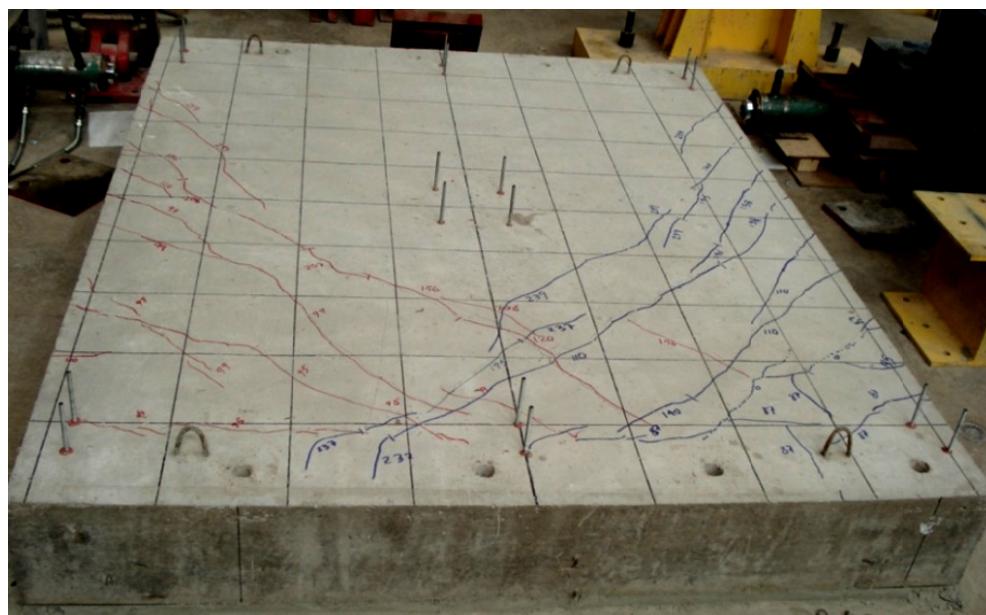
Agrietamiento final del modelo losa 04
